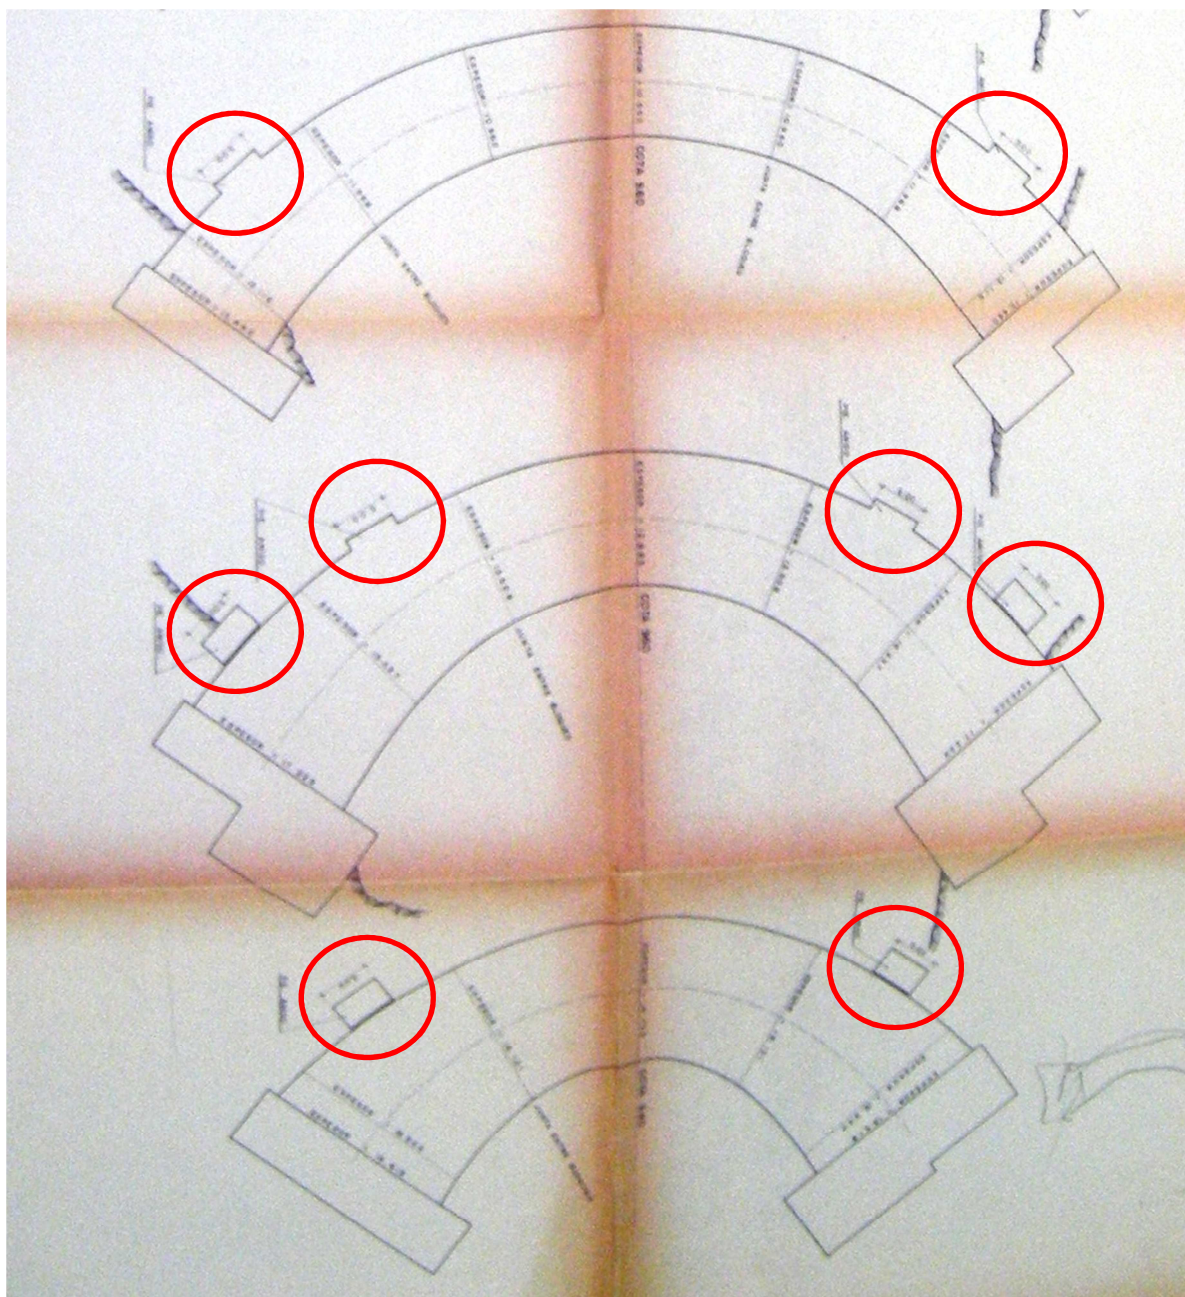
Vista en planta de los "pies amigos" o "muletas de apoyo" en ménsulas laterales.
